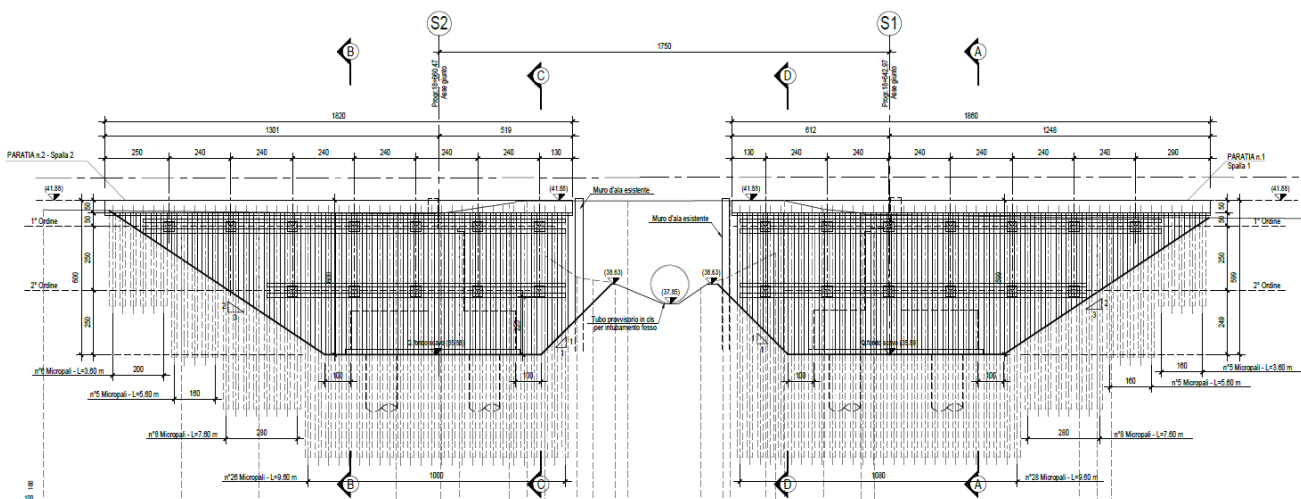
VI03 – PROSPETTO PARATIA DI PE
